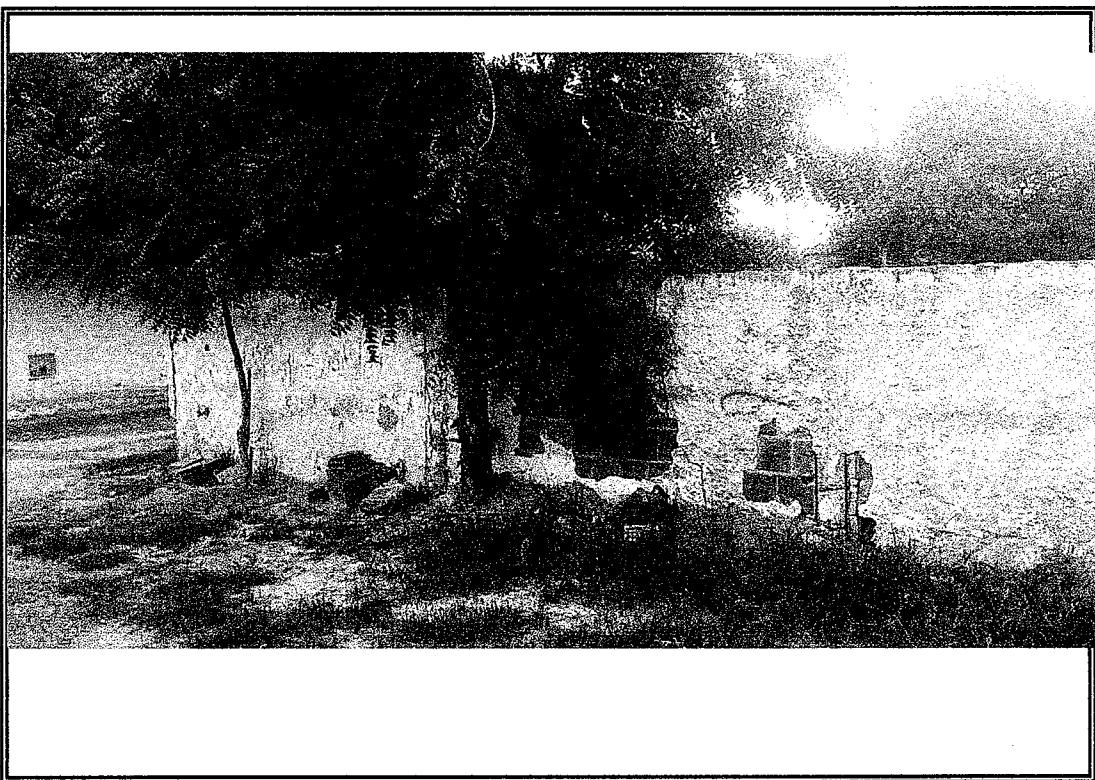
Vista do muro em que será reconstruído revestimentos e aumentado para atender a cobertura.
